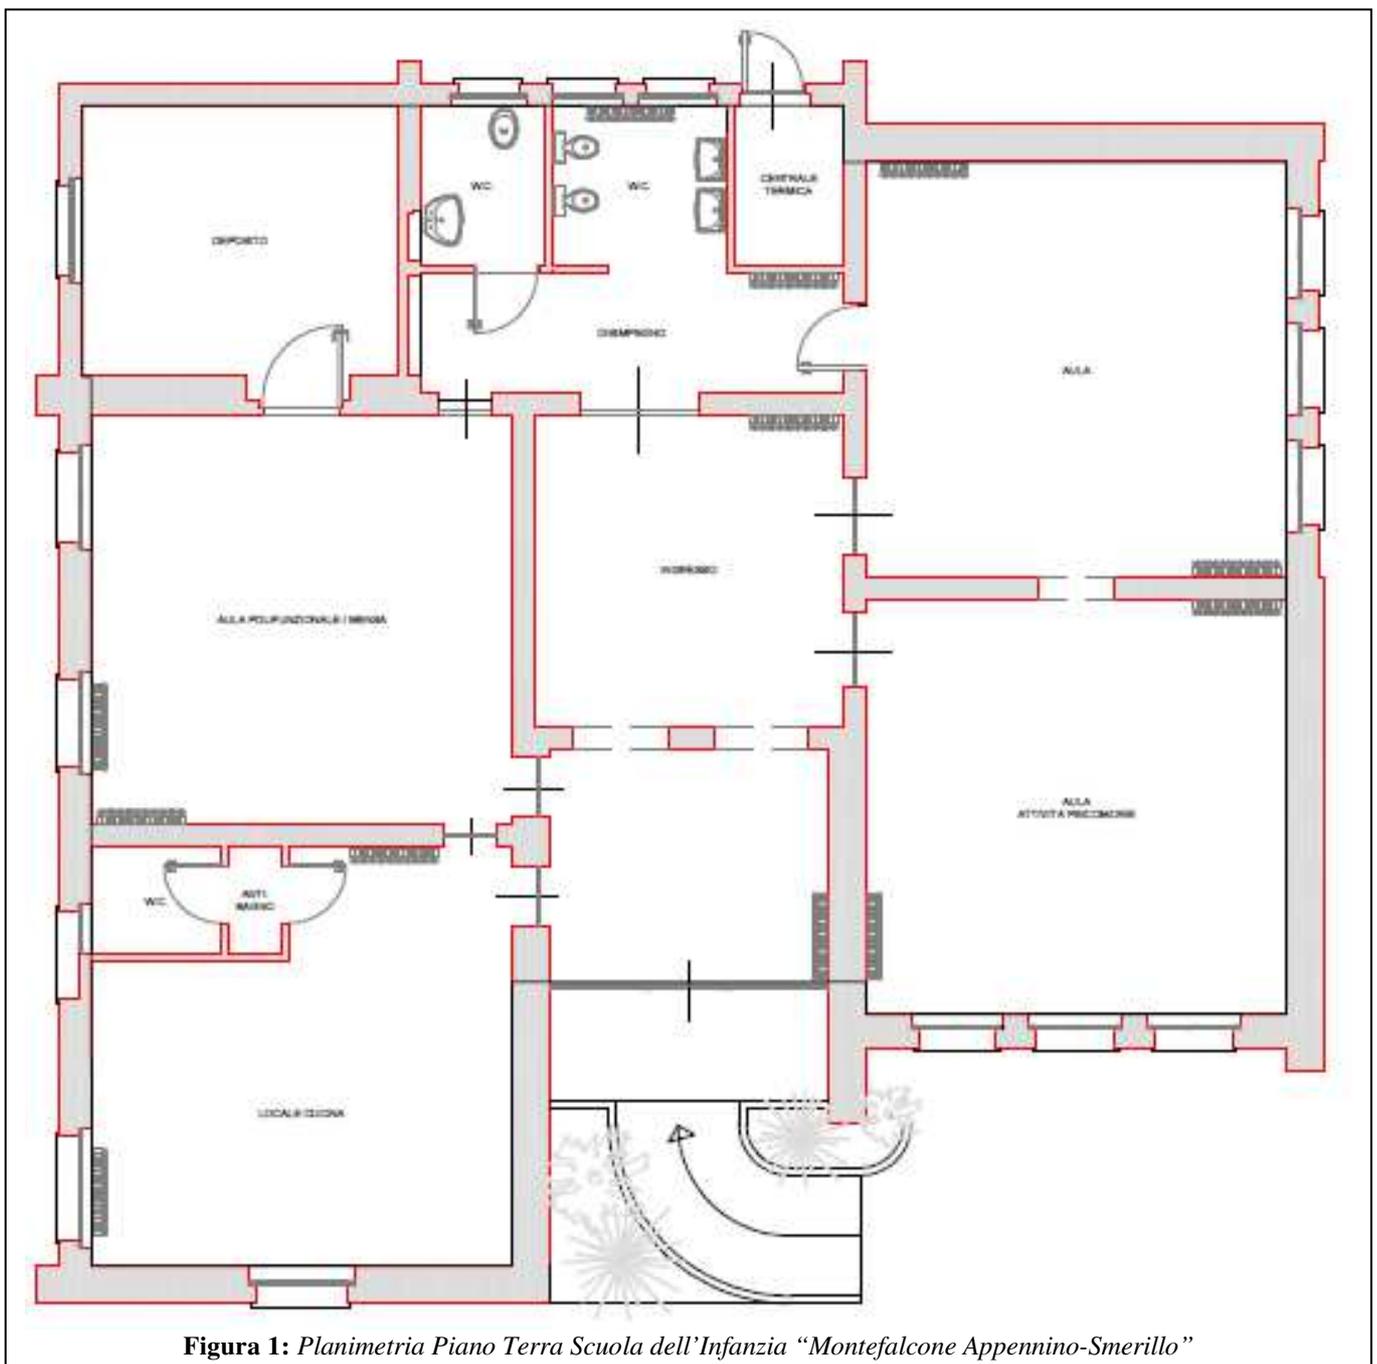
Planimetria Piano Terra Scuola dell'Infanzia "Montefalcone Appennino-Smerillo"
